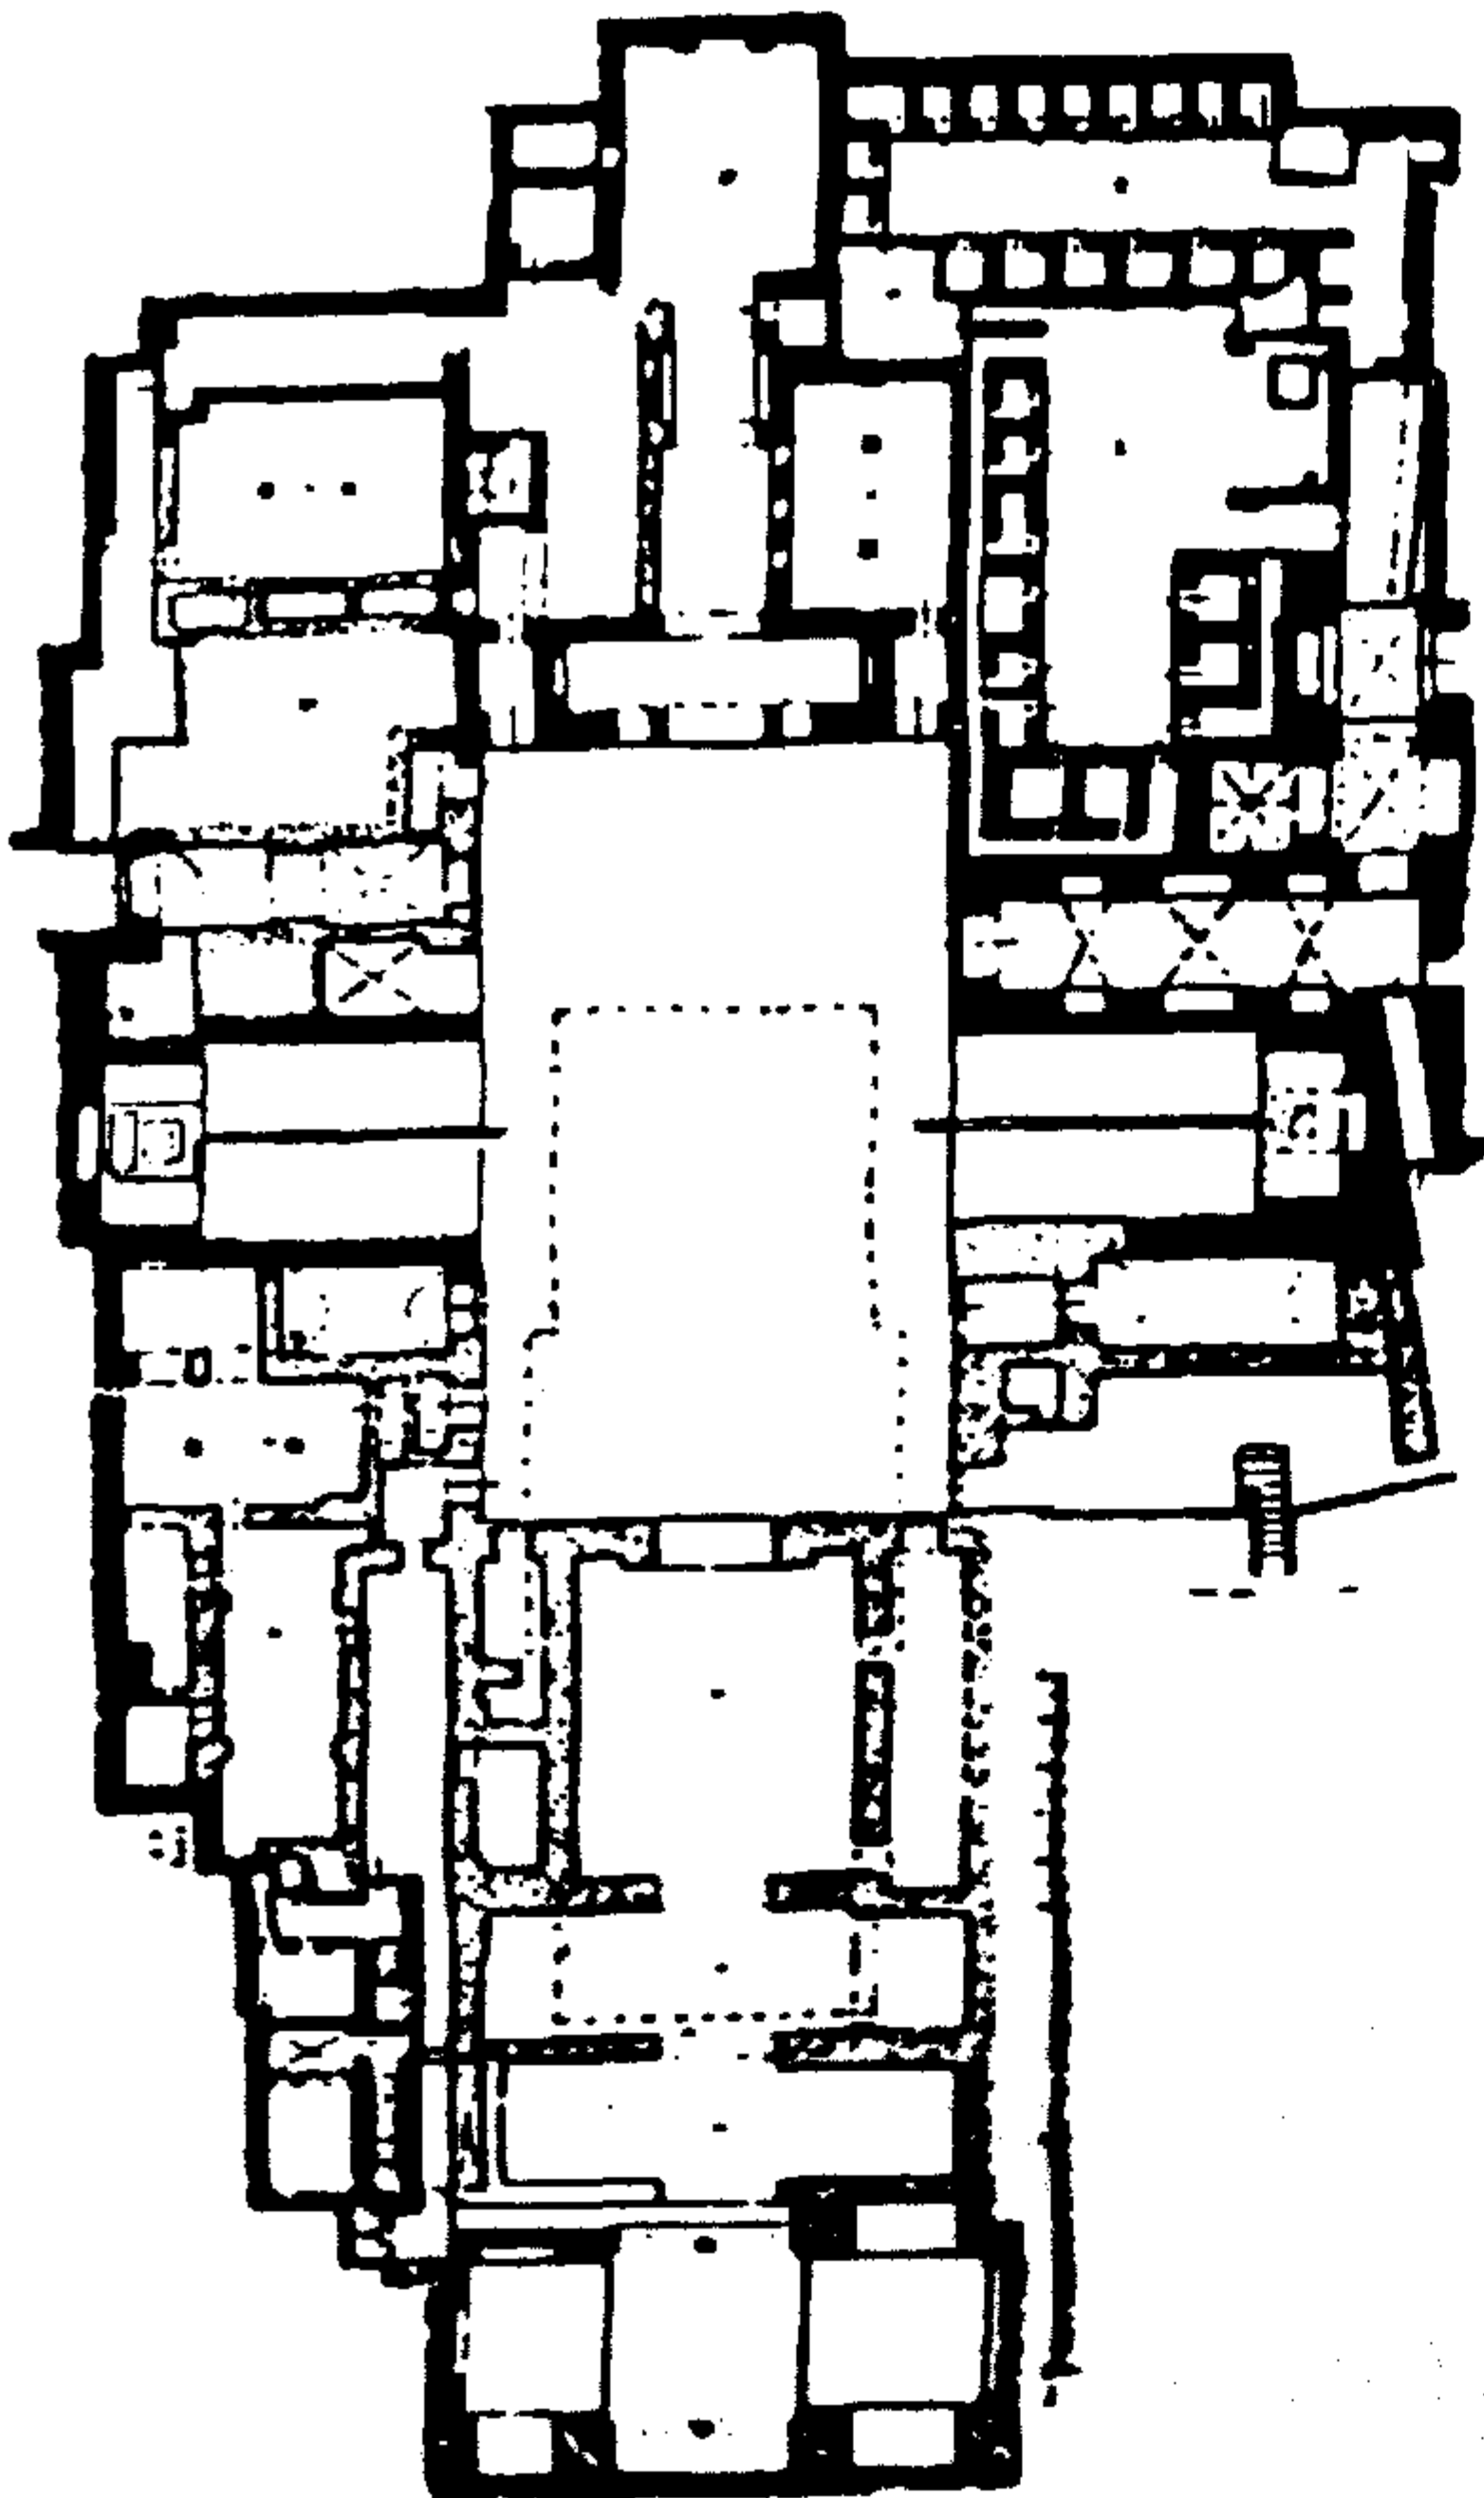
مسقط أفقي لمدرسة السلطان برقوق بالنحاسين.
